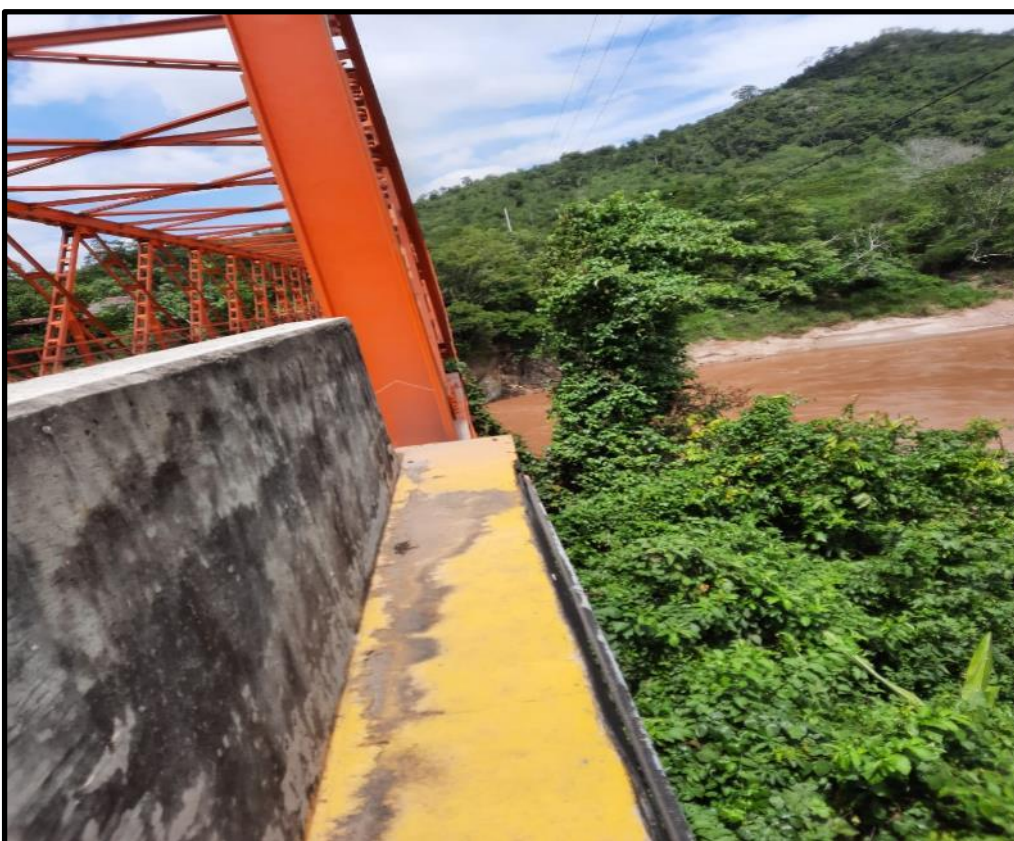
Se aprecia el estado de la guardavia de concreto.
